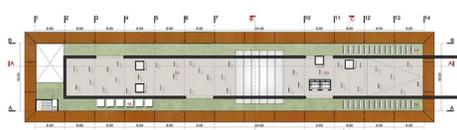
Museu Nacional da Memória Planta Baixa Técnica
